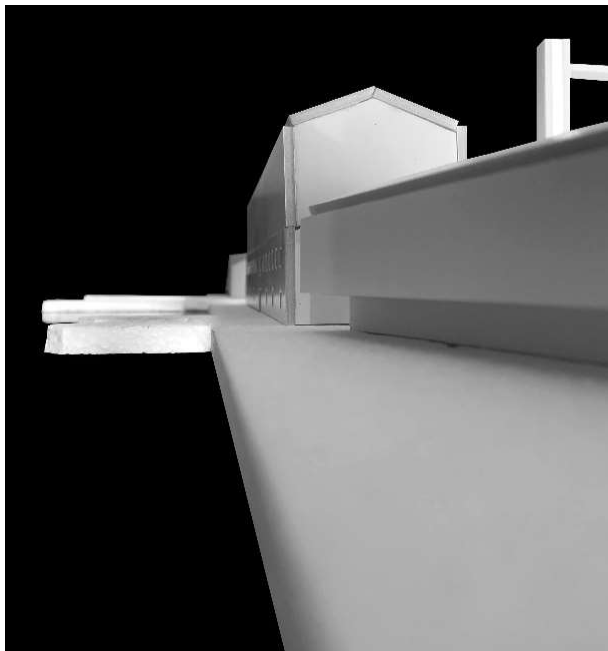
Maquete - Pormenor da fachada recuada do Mercado
